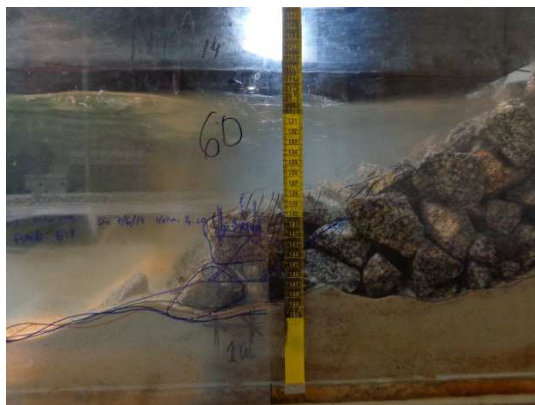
Perfil do fundo e deslocamento da risberma no ensaio 2.2.1
